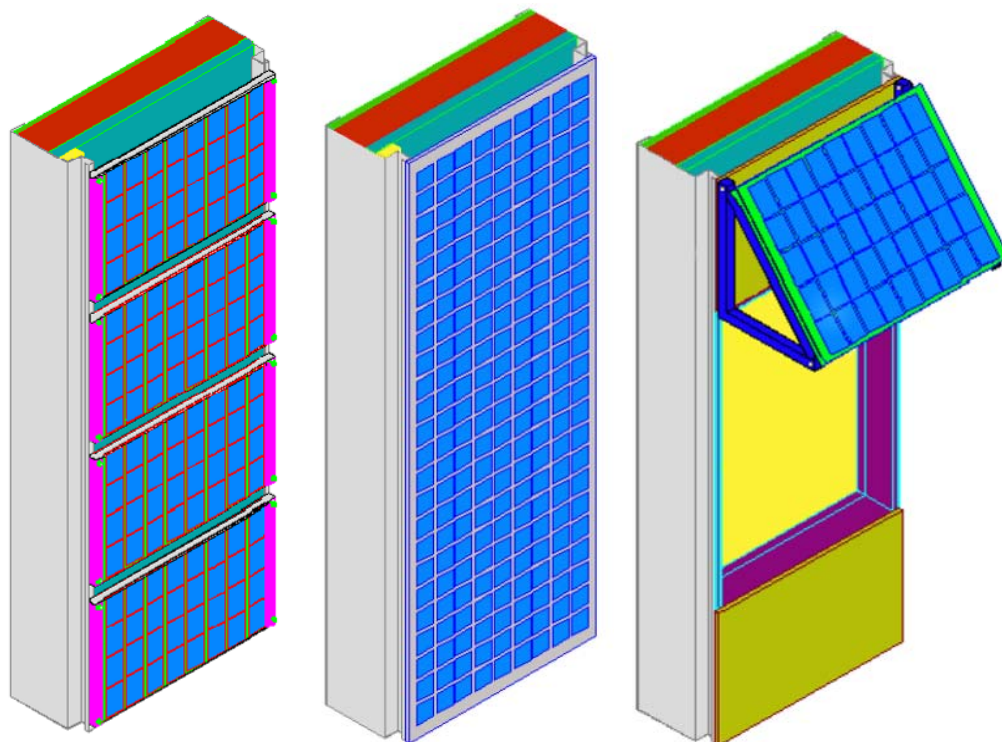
Componente de fachada con placas fotovoltaicas verticales
